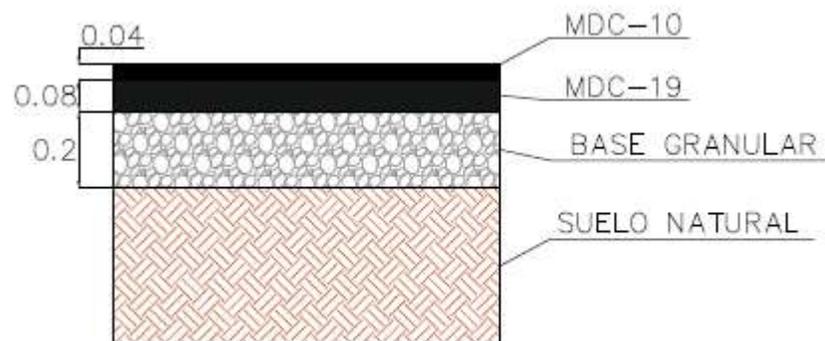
Perfil diseño estructura de pavimento Piedecuesta.
